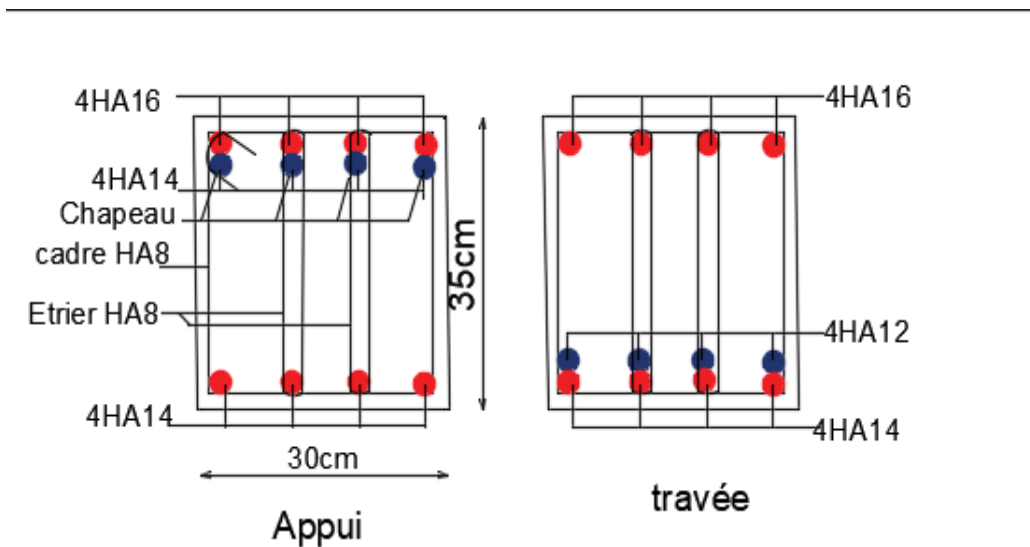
Schéma de ferrailage de la poutre secondaire du plancher RDC
